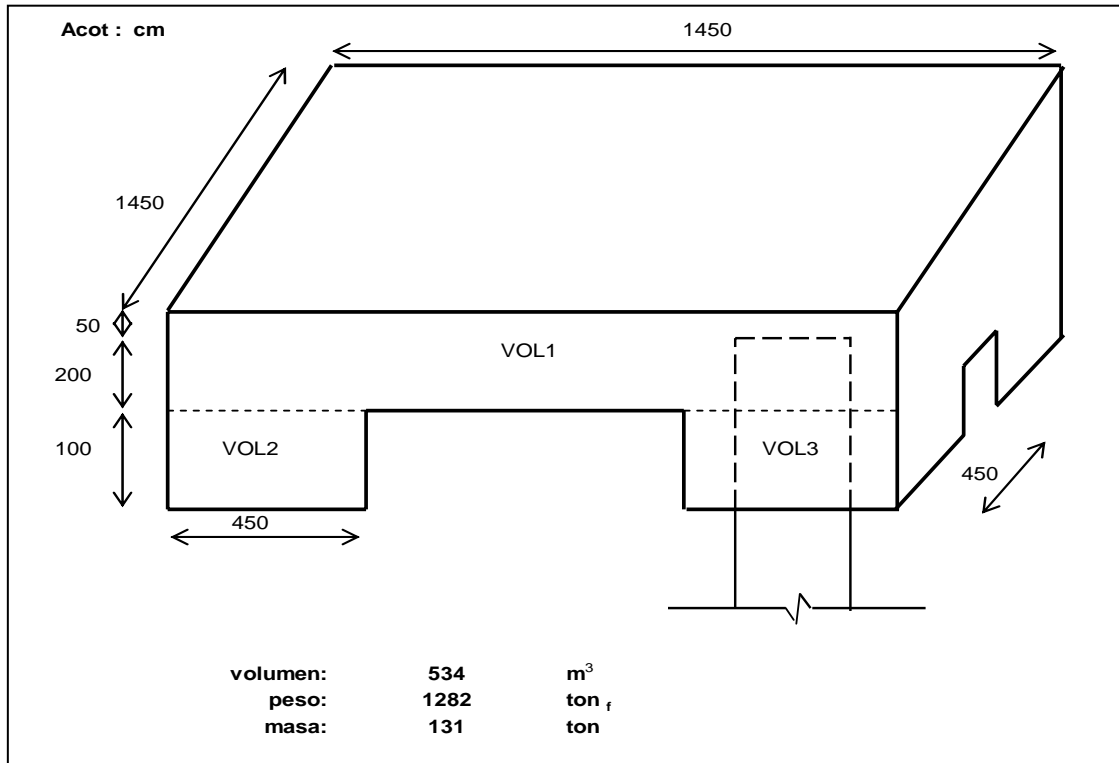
Cabezal 1, para las pilas 2 y 8
